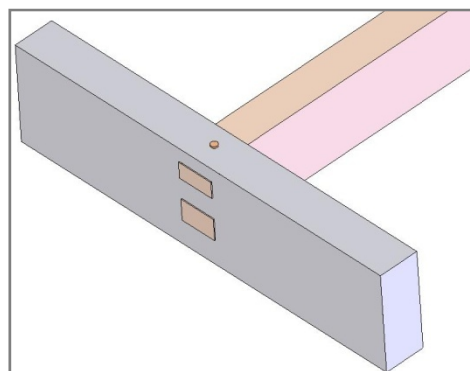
Exemplos de ligações no mesmo plano, numa montagem estrutural de um pavimento.
